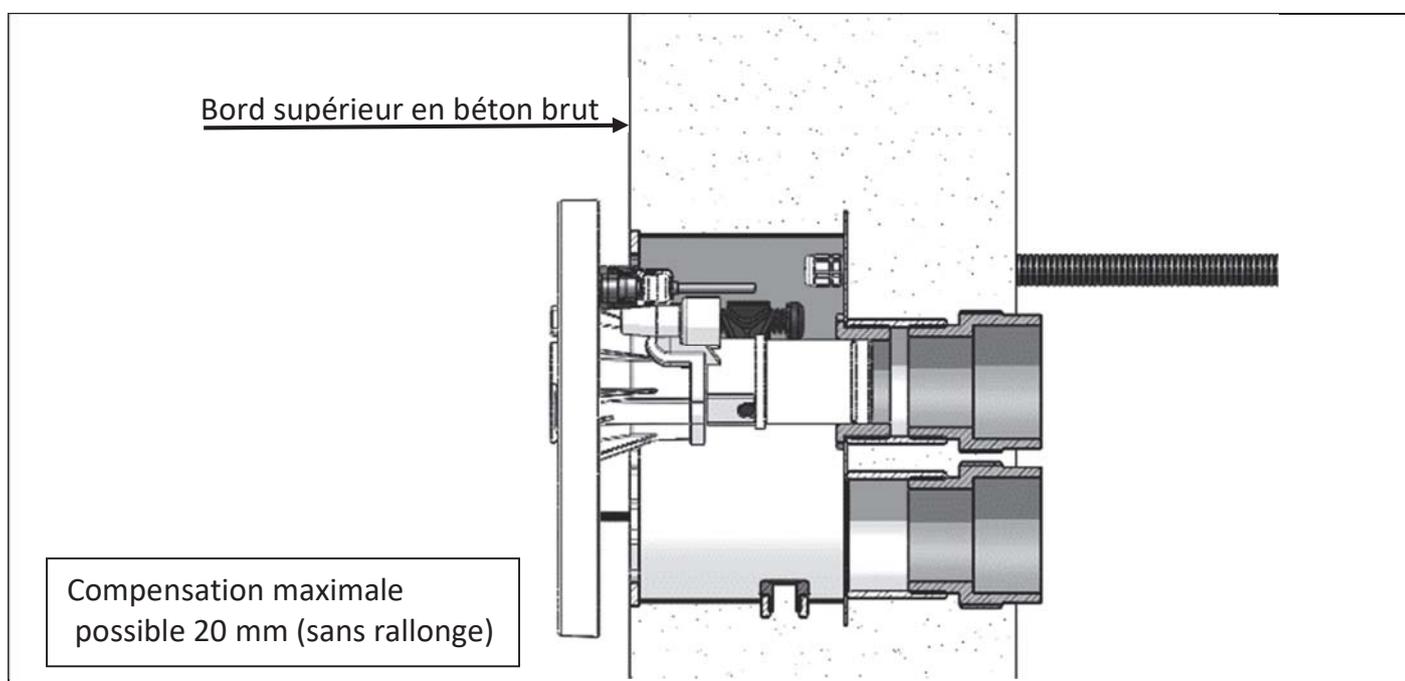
Pièce à sceller en version en inox sert ici d'exemple
